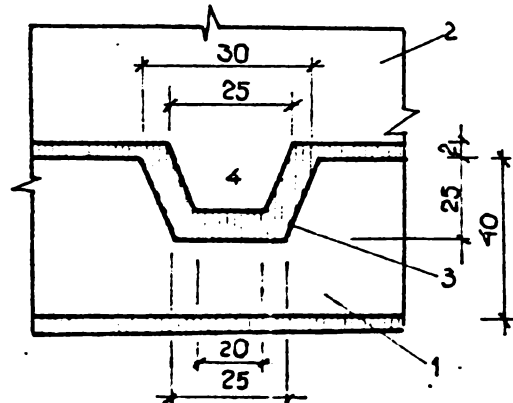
Modul de îmbinare între panoul de elevație și tapla de fundație: 1 - talpă prefabricată; 2 - panou elevație; 3 - mortar de pozi; 4 - prag (dinte beton).
